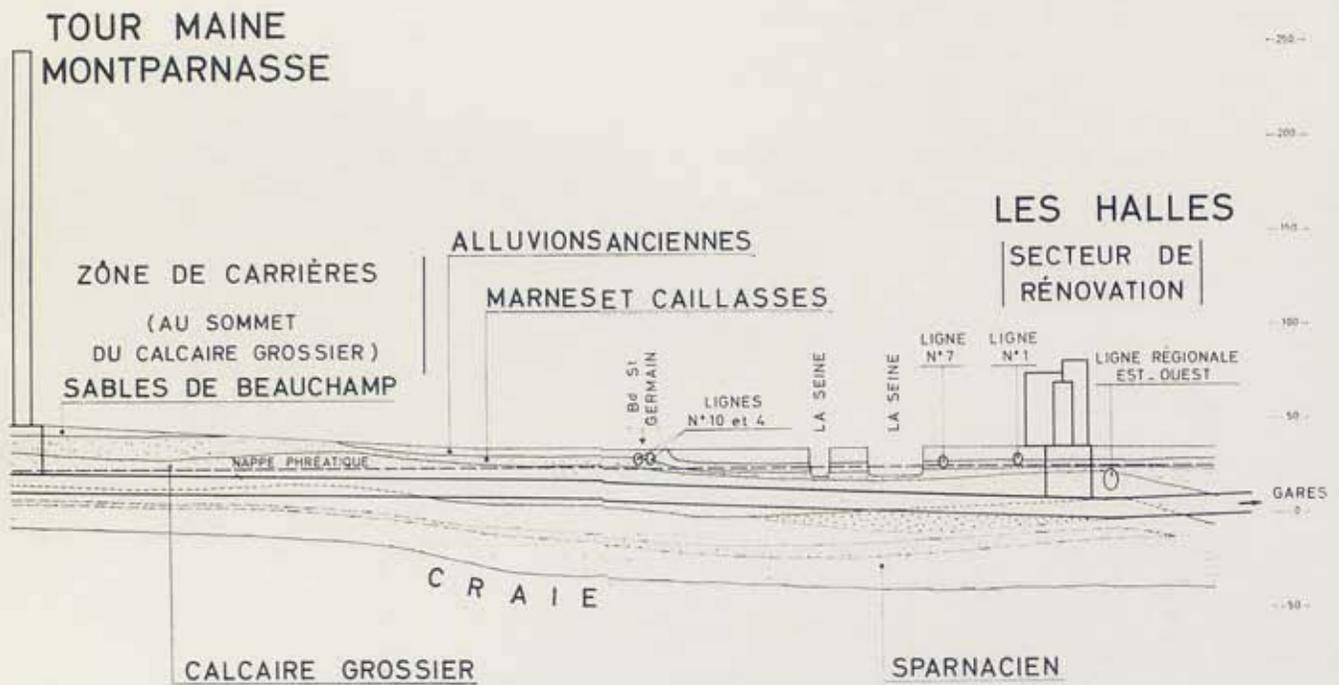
Corte geológico do traçado da via subterrânea sugerida, entre Montparnasse e as Halles
